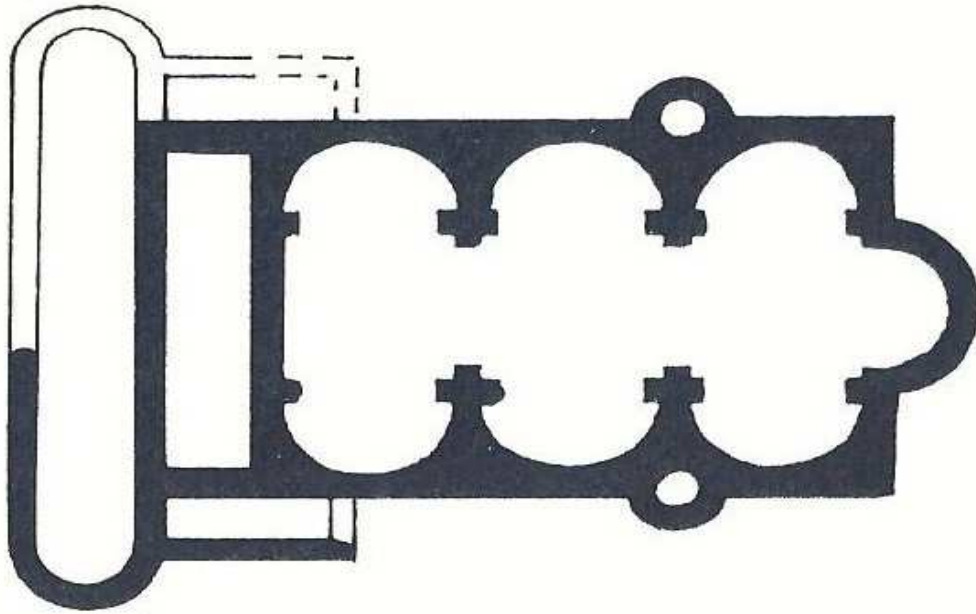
Ejnar Dyggve, Grundriss der Kirche der Vierzig Märtyrer in Saranda, 1938.
